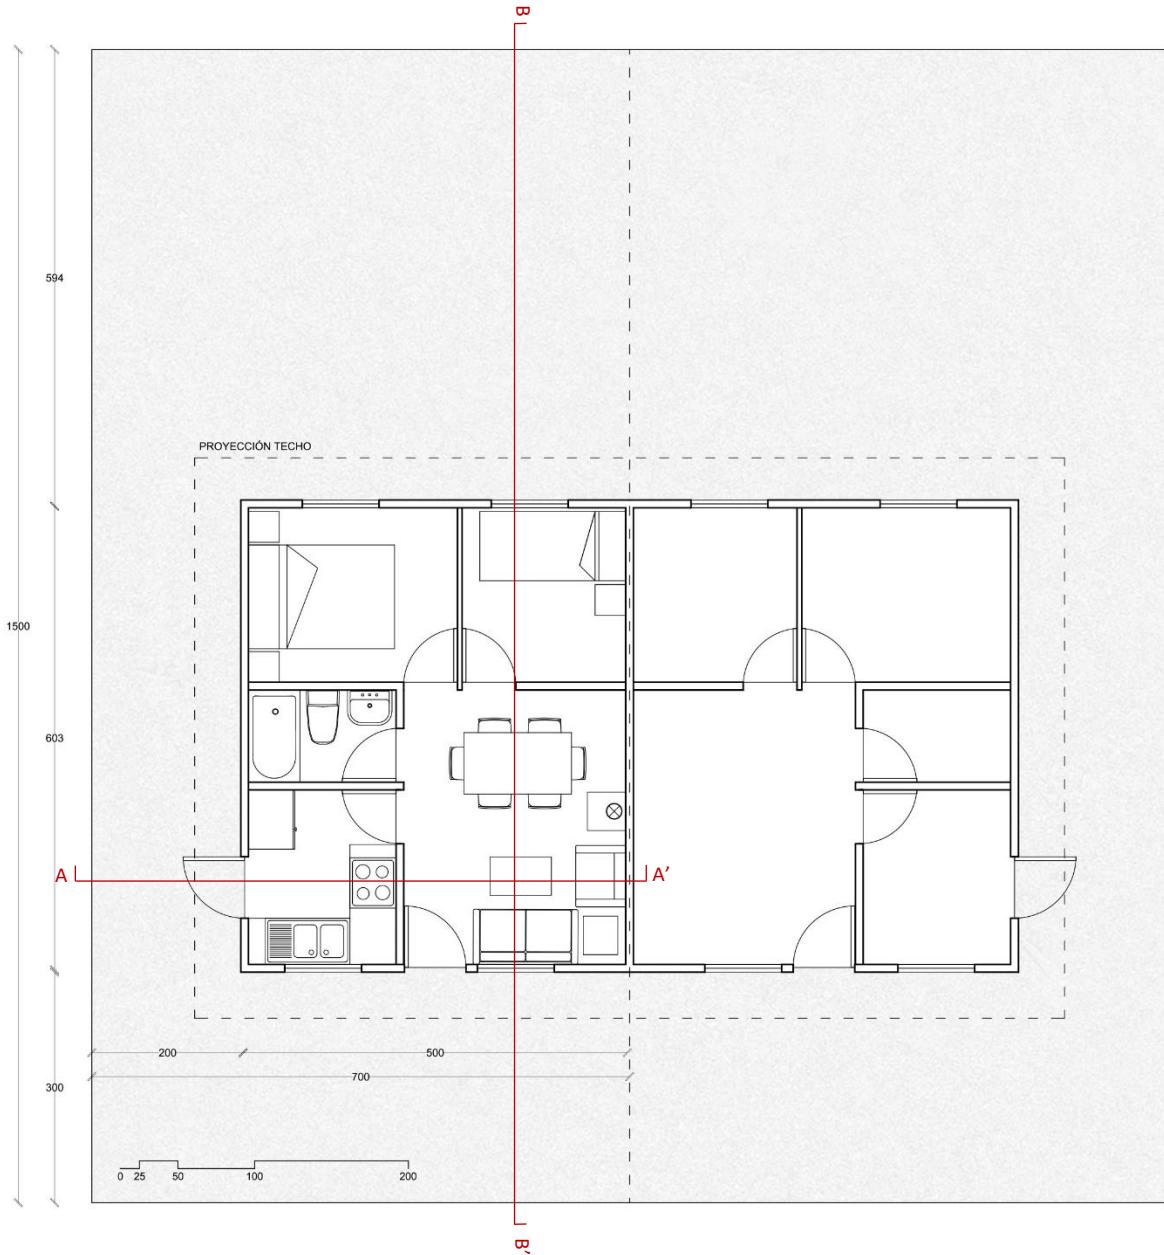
Planta tipología de vivienda estudiada. *Elaboración propia
